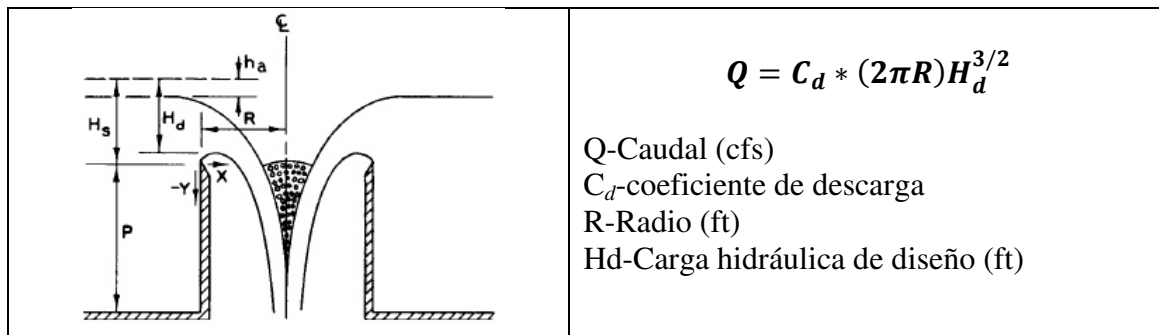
Cálculo de la carga de vertido sobre perímetro circular (Hydraulic Design Criteria)
